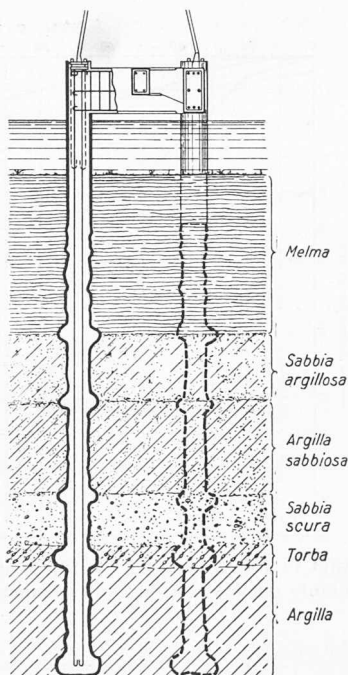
Pfahlfundierung für die Masten Bild 15. Interessant sind im Bodenprofil die heute tiefliegenden Torfschichten. 1:200
